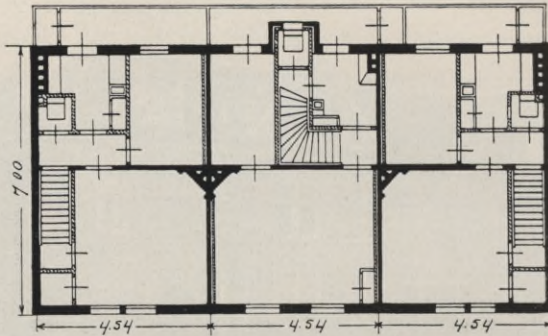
Grundriß Obergeschoß zu Abb. 43.
